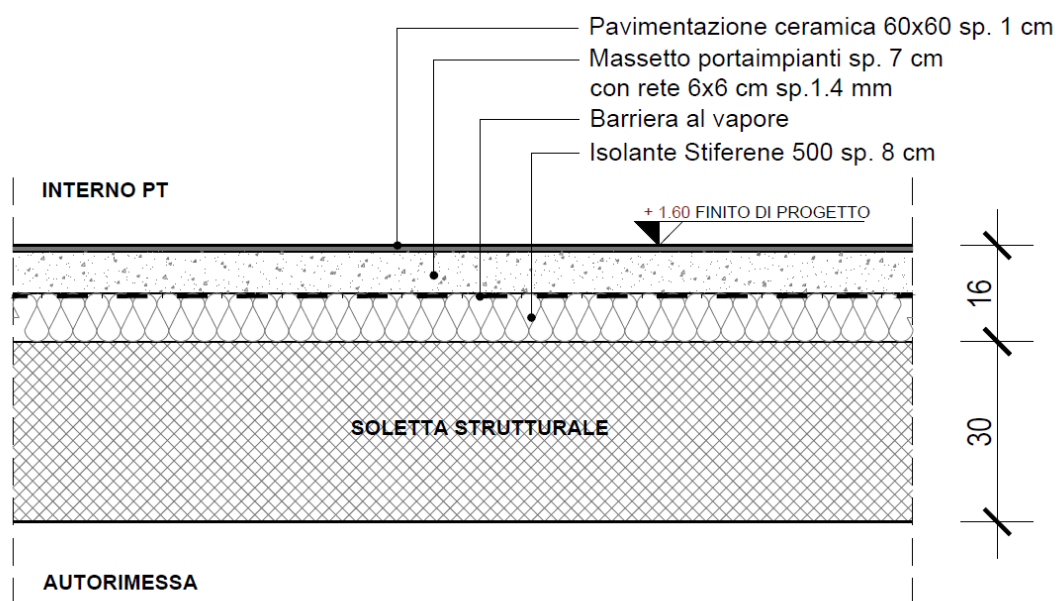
dettaglio della porzione di solaio a piano rialzato previsto sopra l'autorimessa
